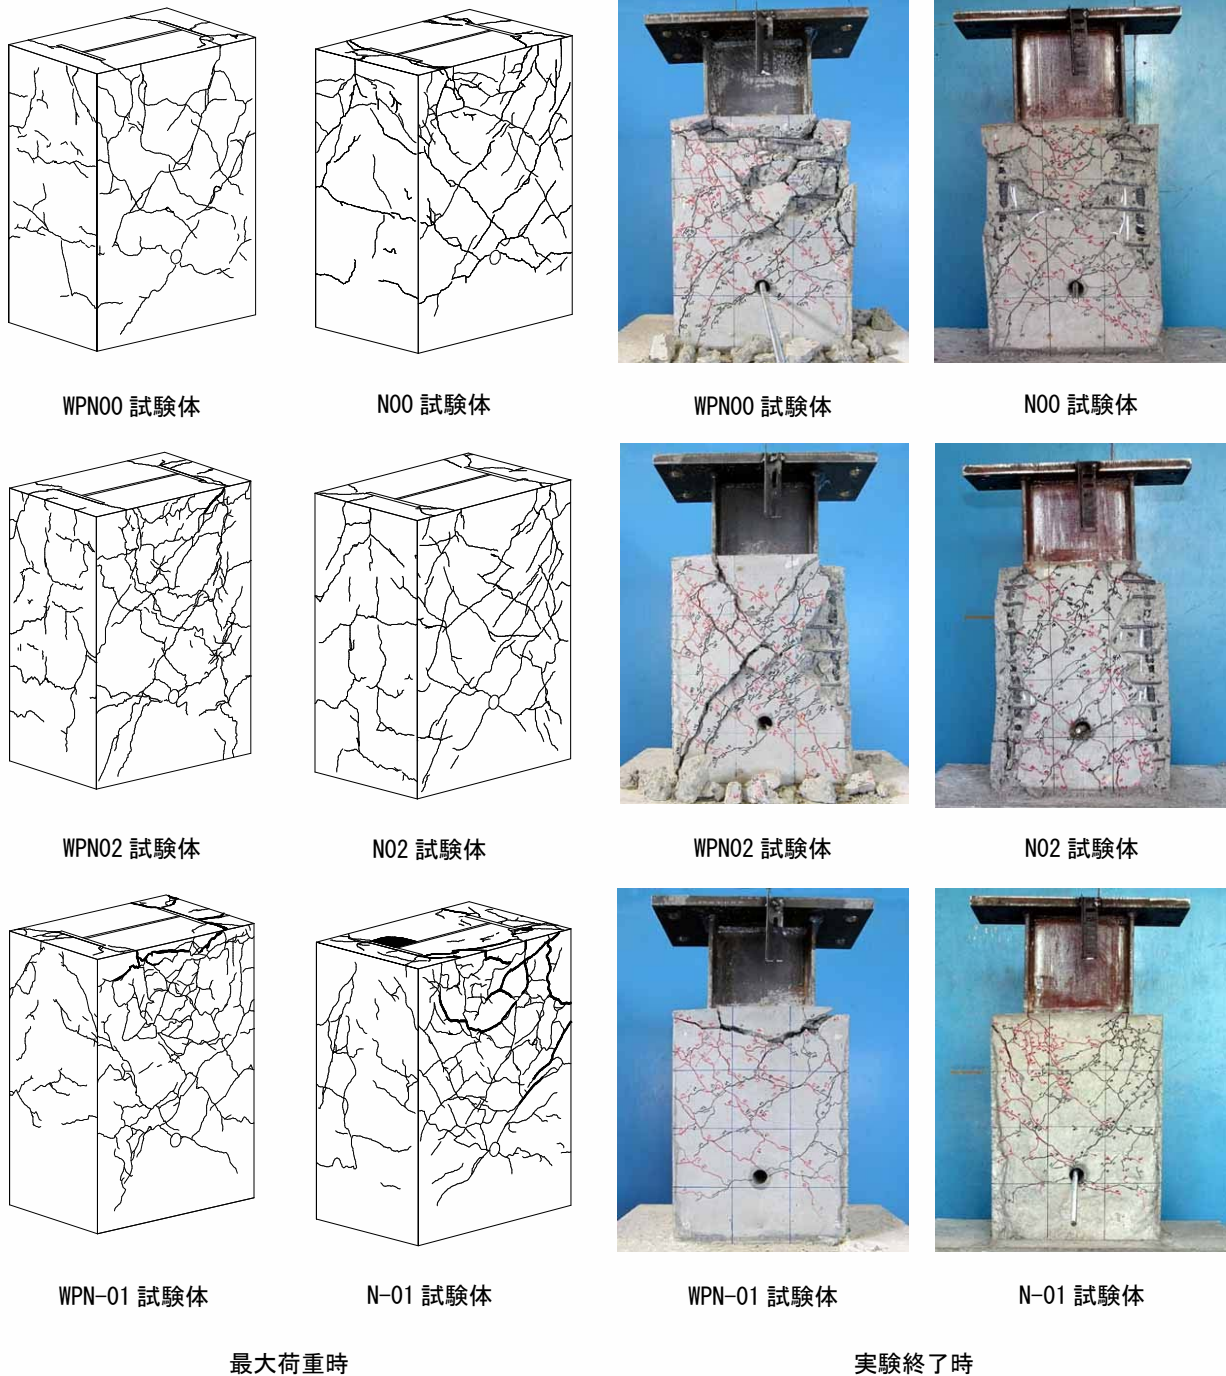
最大荷重時および実験終了時のひび割れ状況
